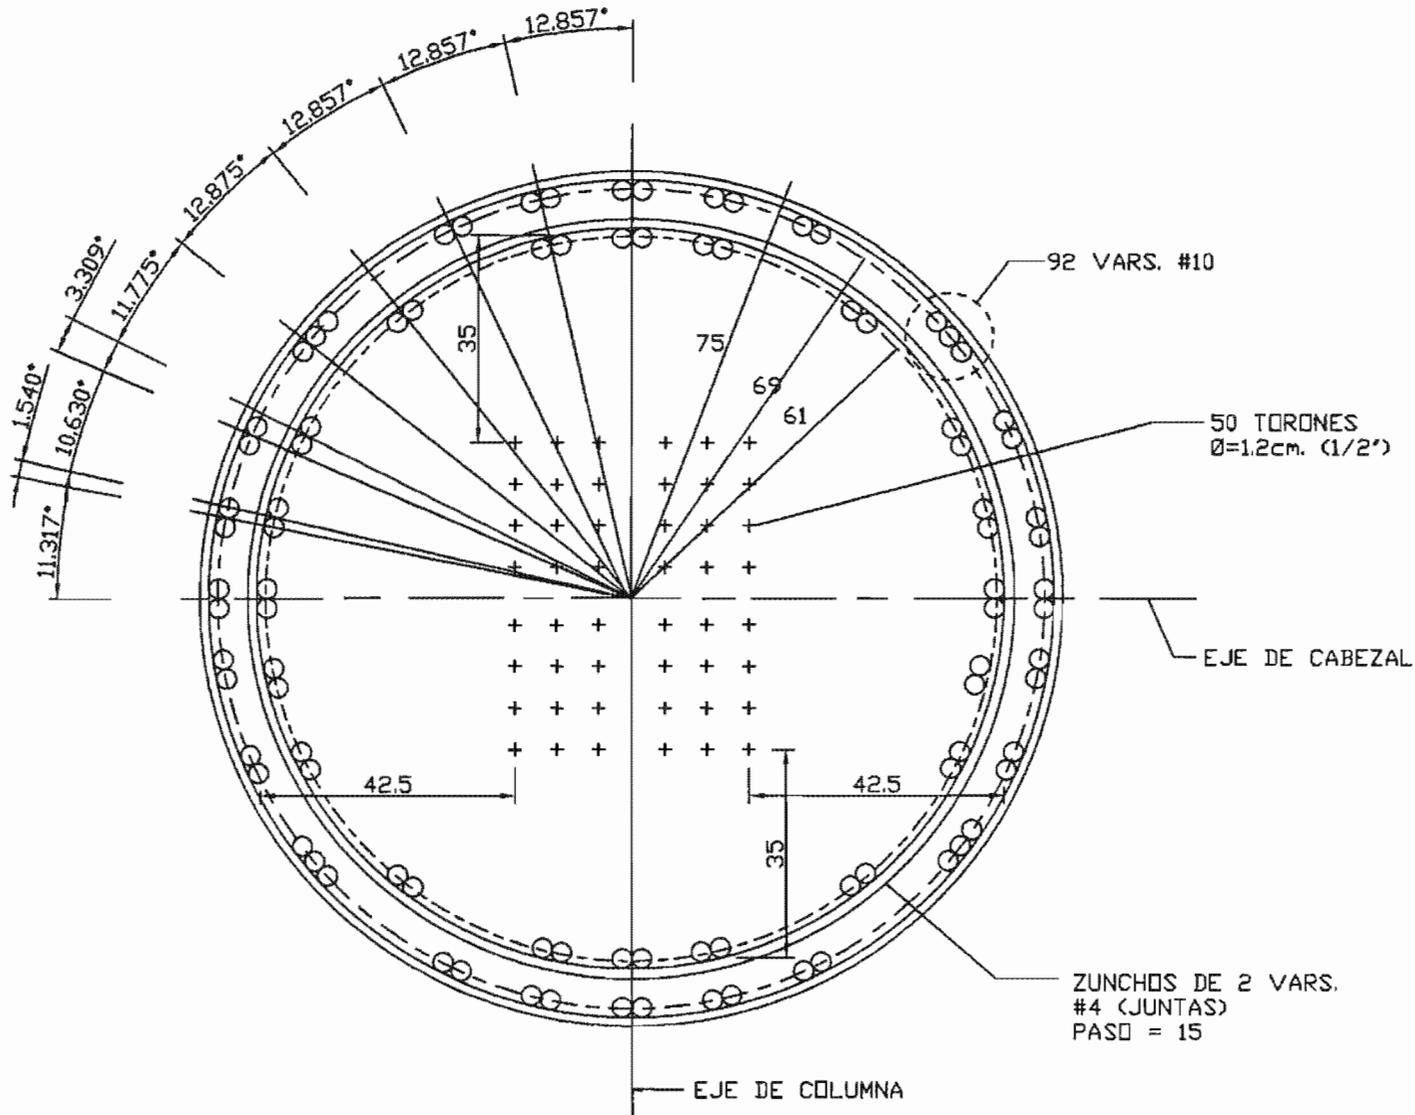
Columnas Tipo I o Mixtas.
